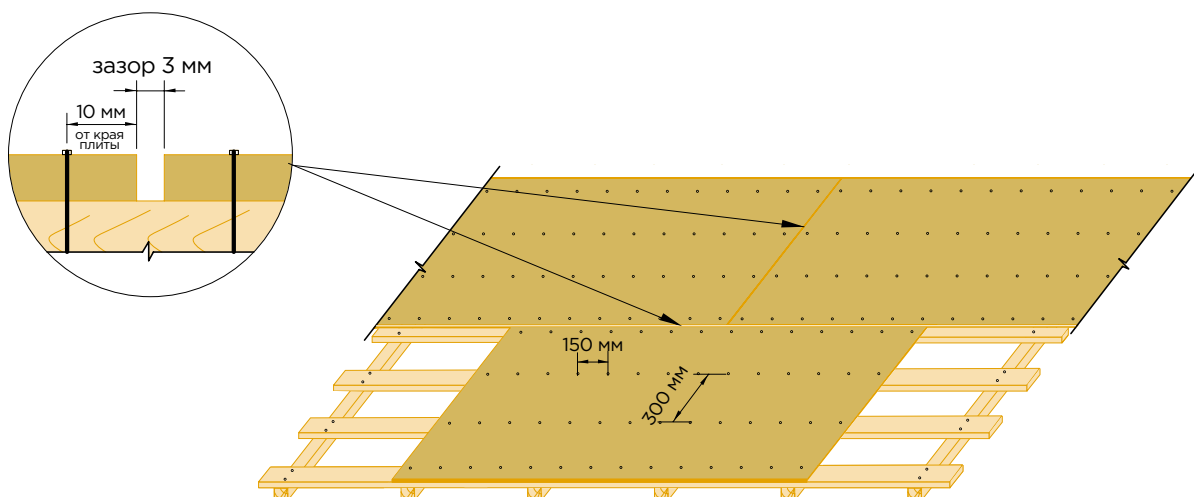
Монтаж сплошного основания из ОСП-3/ФСФ
